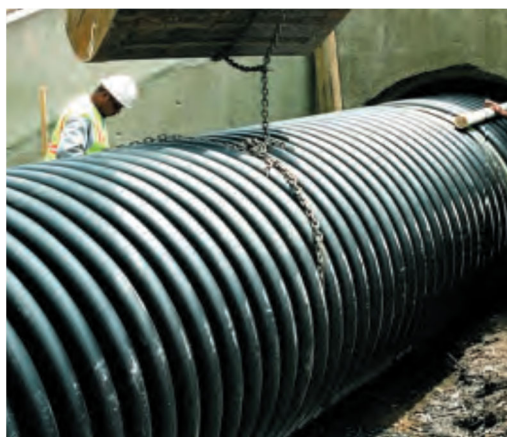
Монтаж металевої гофрованої труби у пошкоджену залізобетонну споруду
